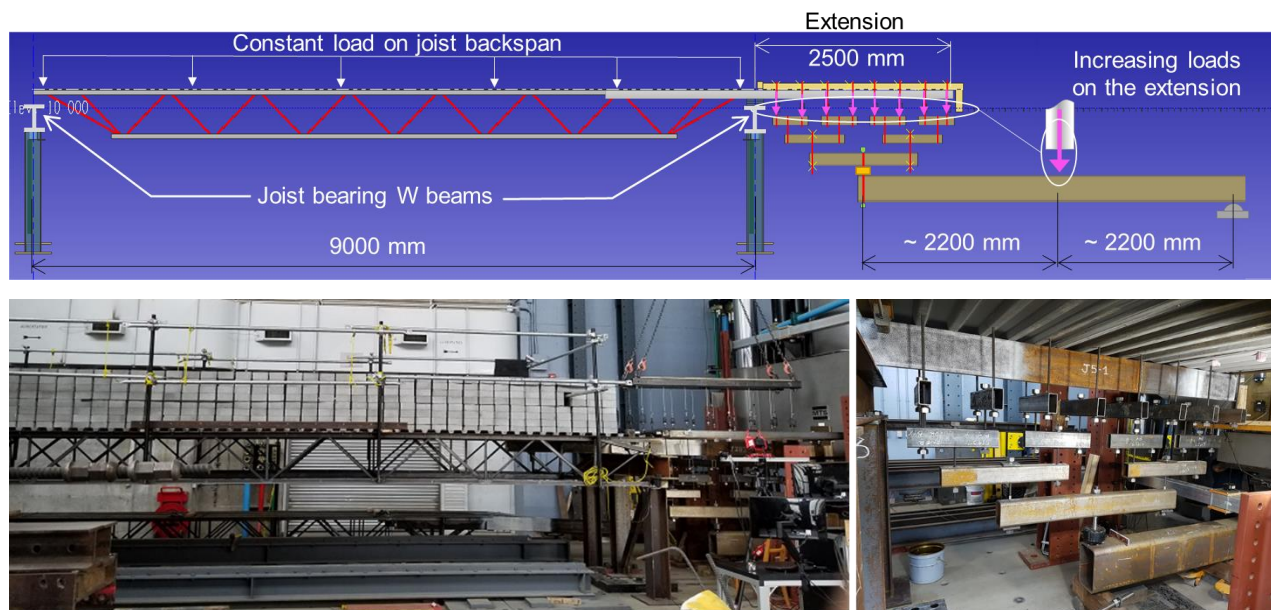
Illustration du montage utilisé pour les essais de flexion sur extension de corde supérieure de poutrelle.
